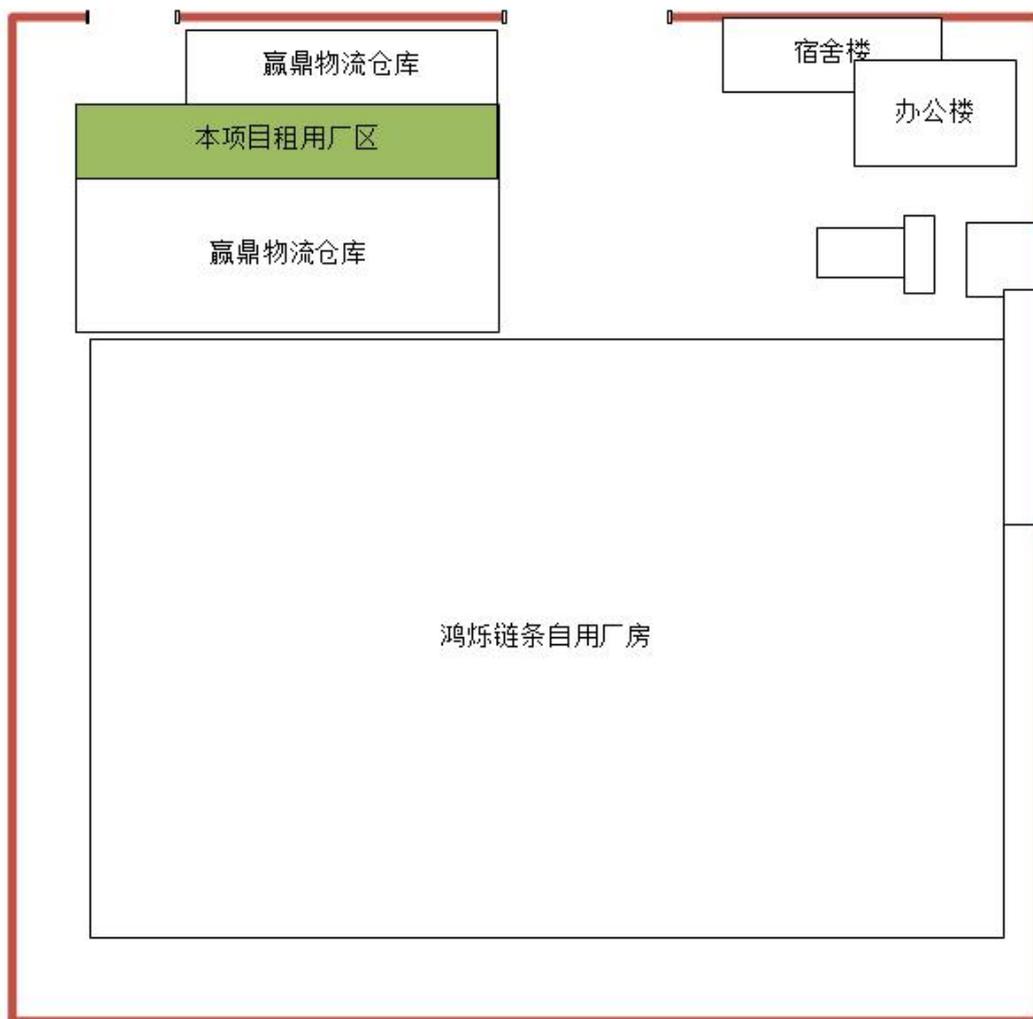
金华鸿烁链条有限公司厂区平面布置图
